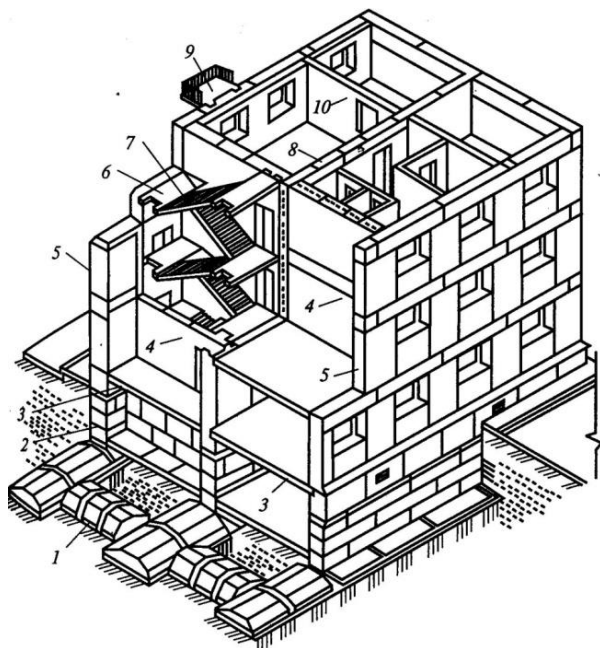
Конструктивная схема здания: 1 – фундамент; 2 – стены подвала; 3 – перекрытия; 4 – внутренние стены; 5 – наружные стены; 6 – лестничная площадка; 7 – лестничный марш; 8 – внутренняя несущая стена; 9 – балкон; 10 – межкомнатная перегородка
